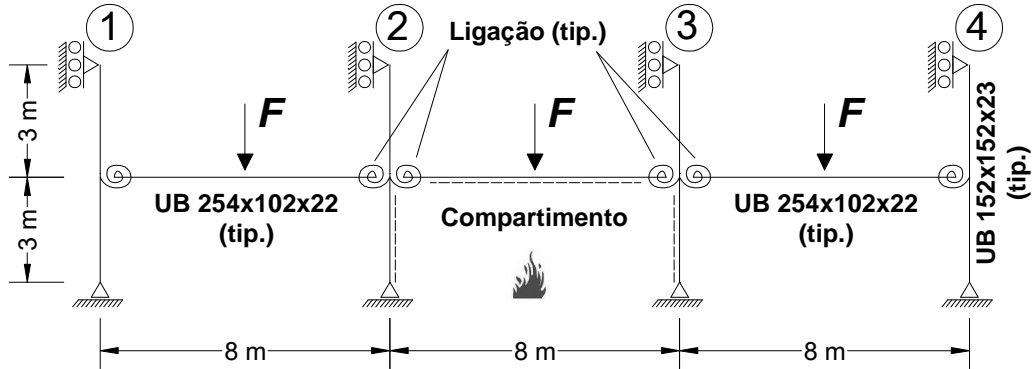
Pórtico estrutural de 2 andares proposto.
